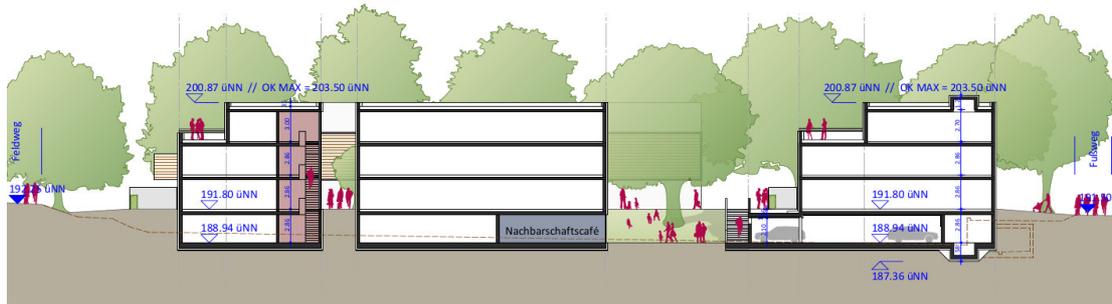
Städtebauliches Konzept, Schnitt West-Ansicht (WOHNBAU MAINZ, Stand: 27.11.2020)
